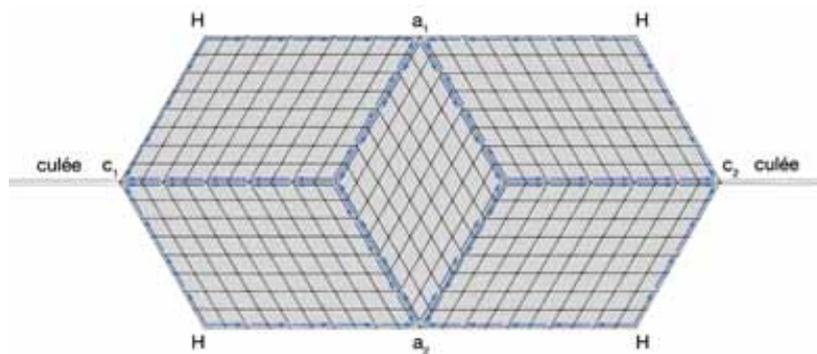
Schéma de la toiture du complexe sportif de Genk - Vue en plan⁶
